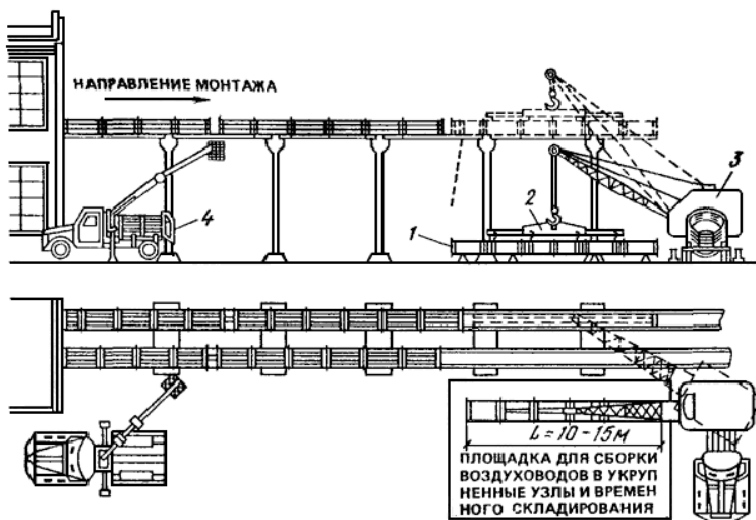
Схема организации рабочей зоны при монтаже горизонтальных воздухопроводов на эстакаде:
